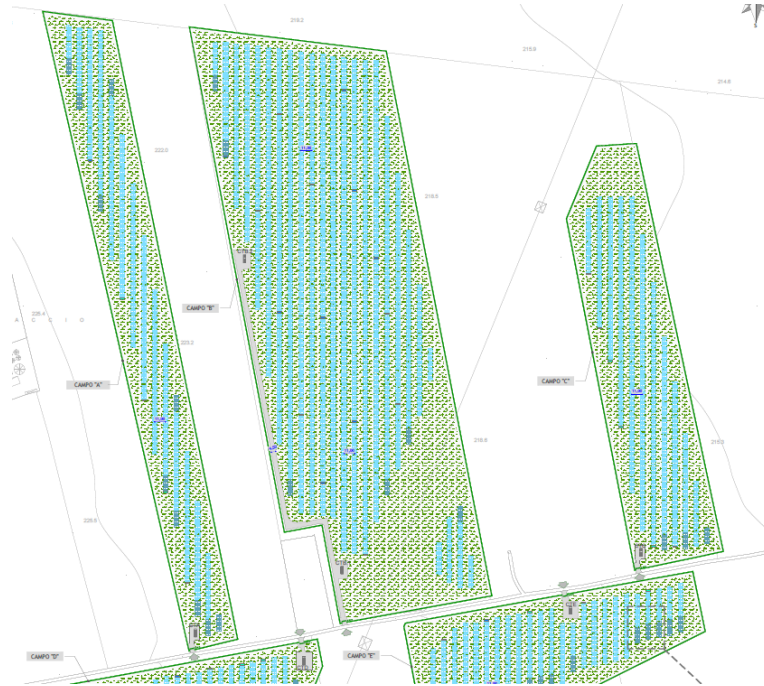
Planimetria dell'Impianto Fotovoltaico – Campi A, B, C
